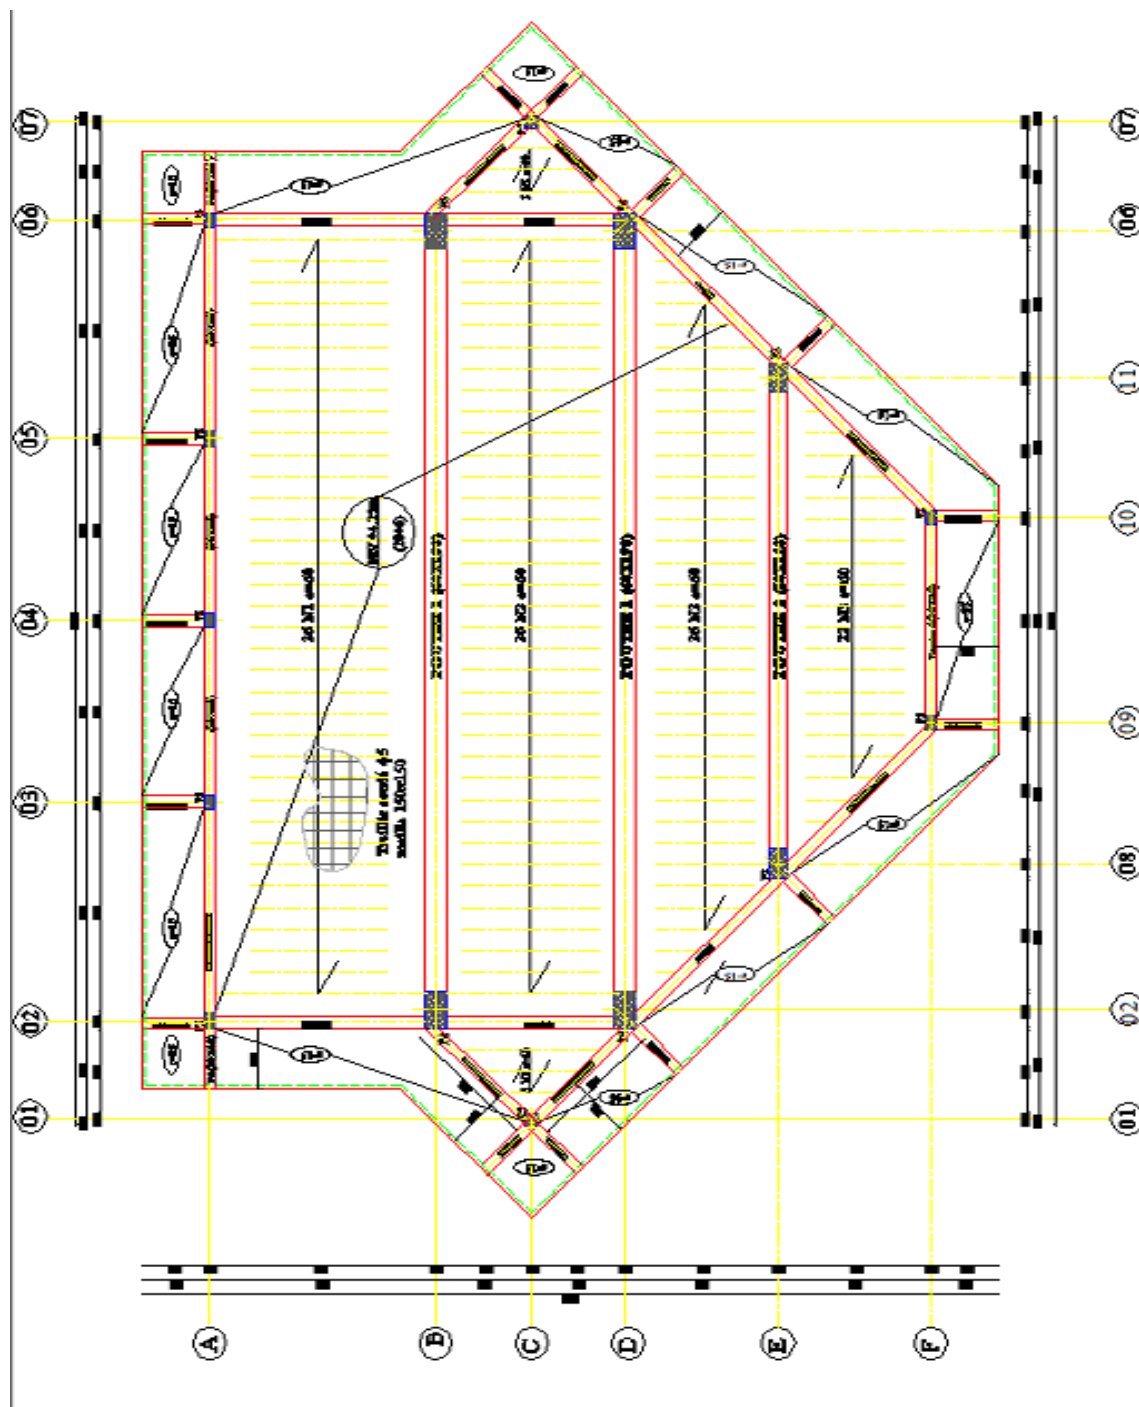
Coffrage plancher échelle 1/200. [2]
